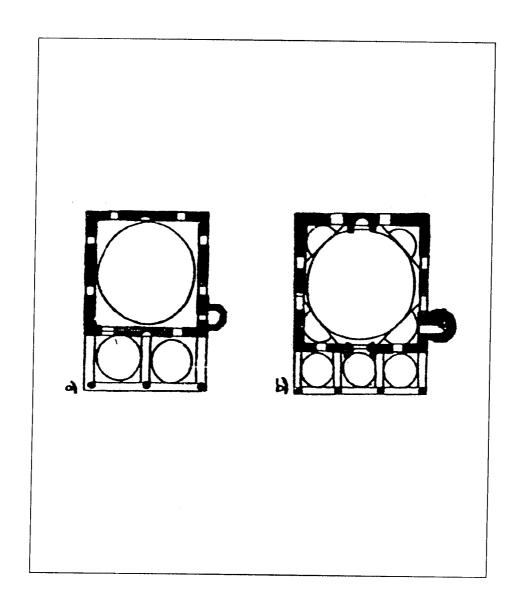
مسقط أفقي لمسجد الفاتح في برشتينا (عن : اصلان ابا) .
